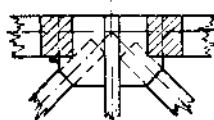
Узел двухстенчатой фермы с непосредственным прикреплением элементов решетки к вертикалам пояса
